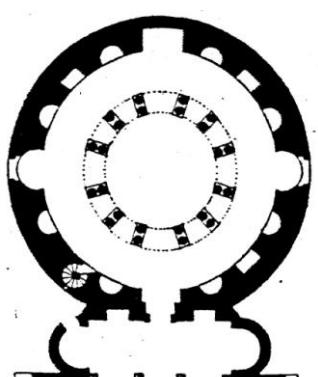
Planta de Santa Constanza, Roma, século IV (Planta)
